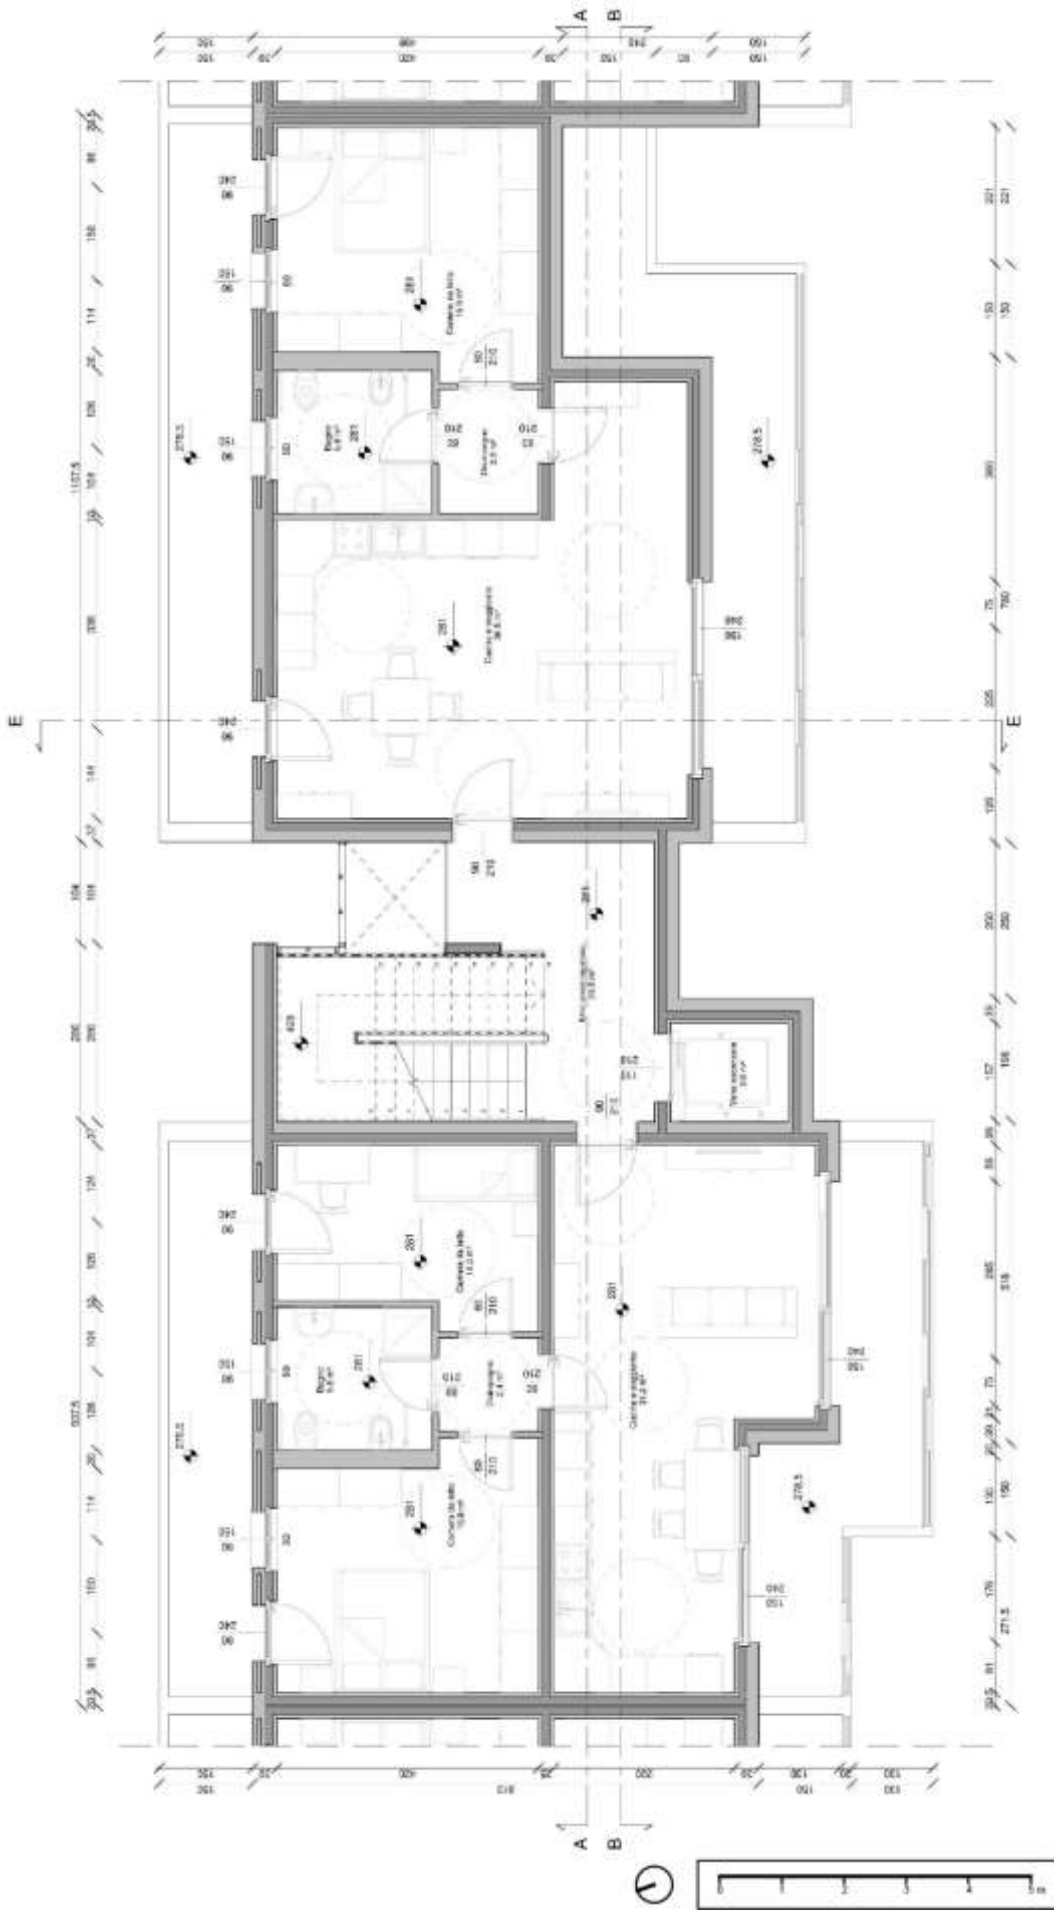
Pianta P01 del Blocco C. [Fonte: elaborazione dell'autore]
